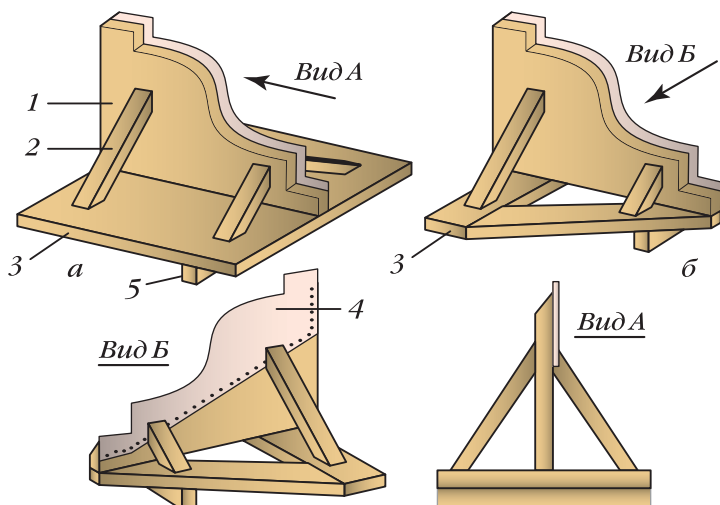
Шаблон для вытягивания поясков и карнизов: а — простой, для стен и усенков; б — угловой, для стен и лузг; 1 — профильная доска; 2 — укосы; 3 — салазки; 4 — профильный фартук из стали; 5 — полозок
